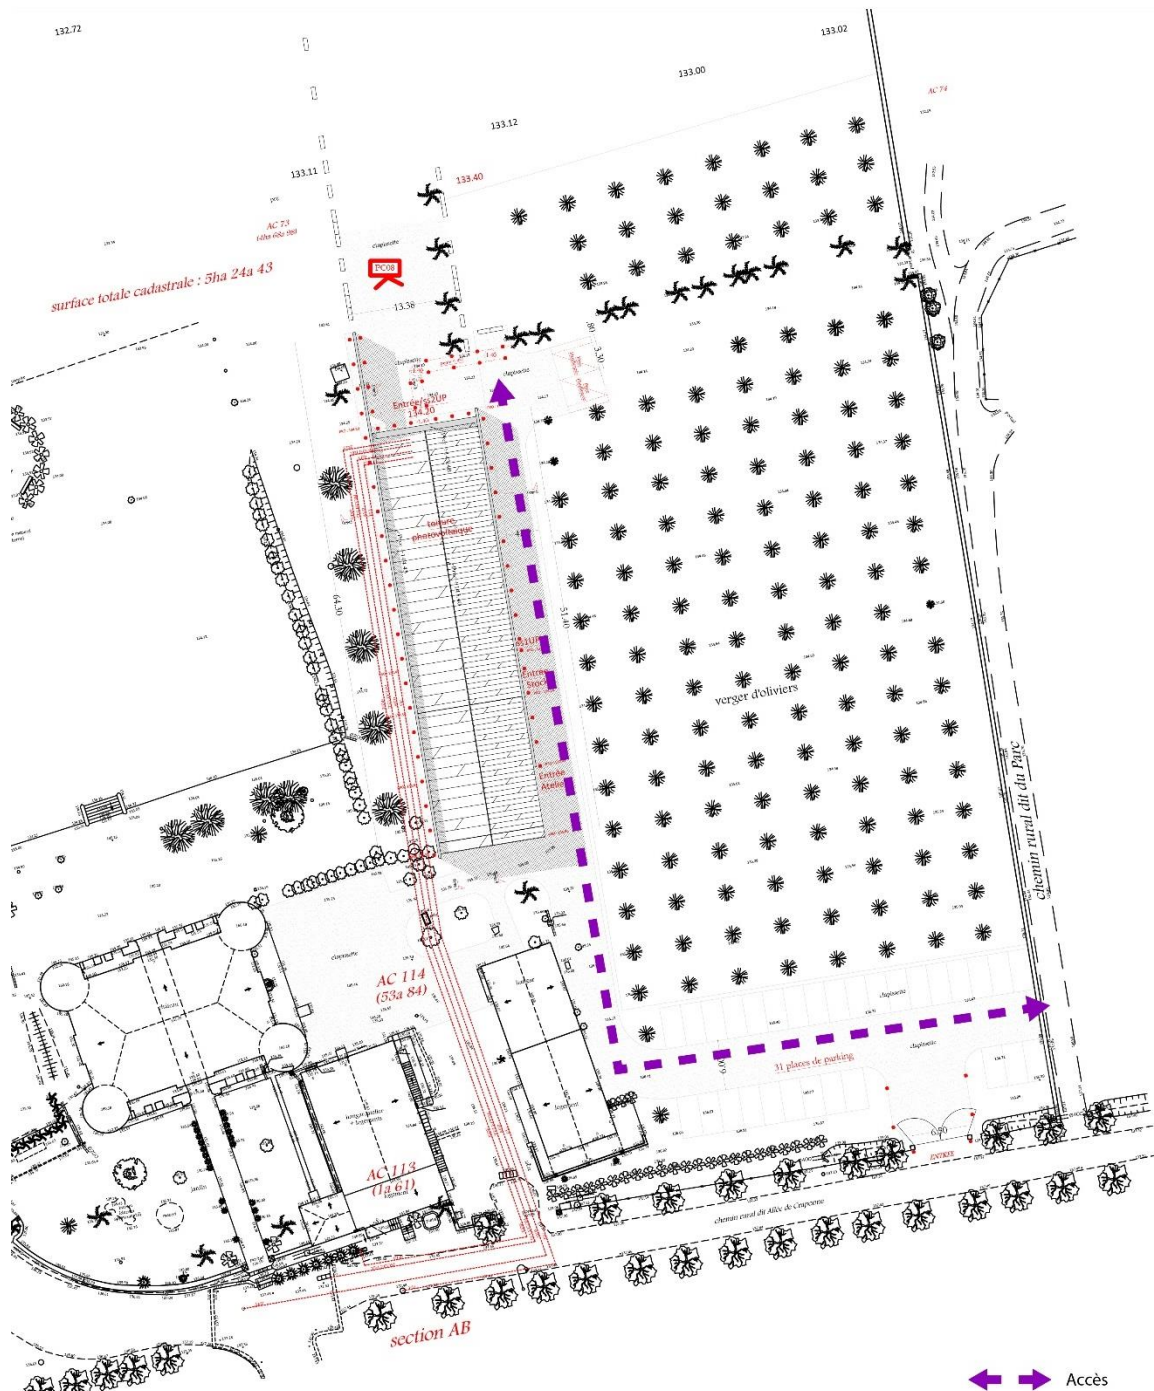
Plan de Masse du projet de Maison des Artistes – Principes d'accès
